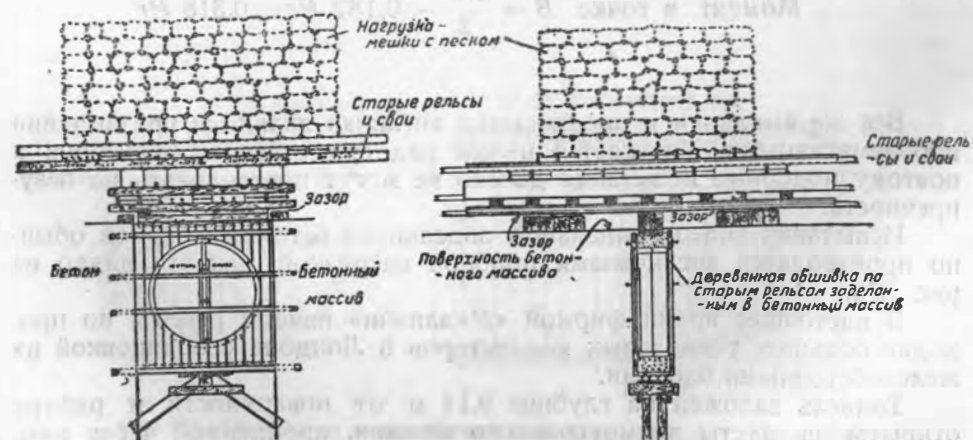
Схема организации пробной нагрузки при испытании бетонных блоков.
